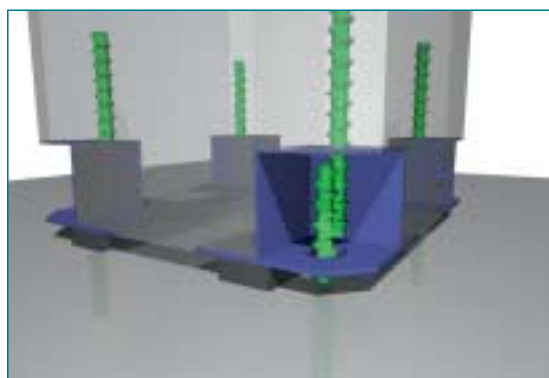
La columna prefabricada (o viga) con conexión rígida obtenida por solapes extremadamente cortos de armadura de compuesto de alto rendimiento.
